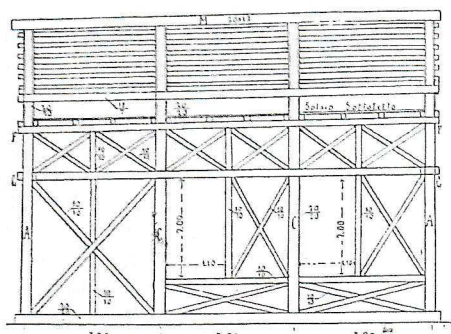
ª — CASTROLIBERO. Ossatura in legno; prospetto.
